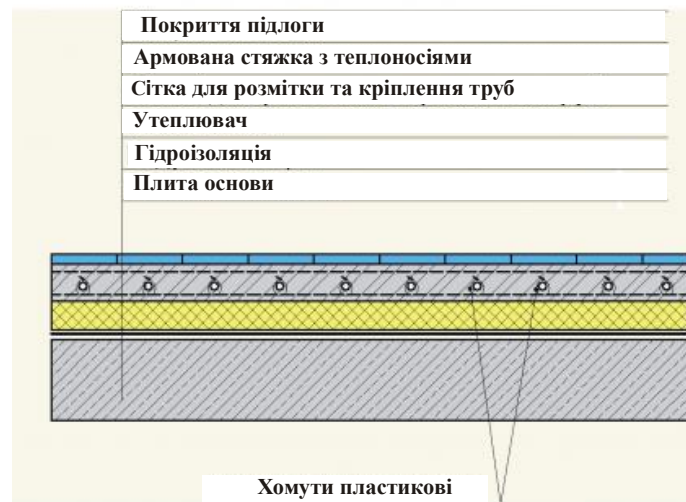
Схема теплої підлоги з кріпленням труб хомутами до арматурної сітки
